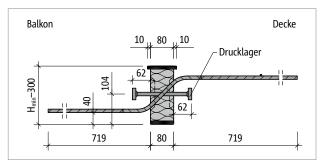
Schöck Isokorb® T Typ QP-V7: Produktschnitt
